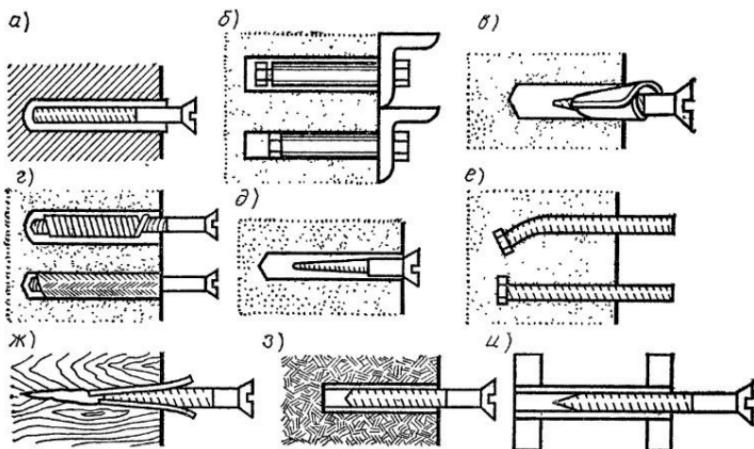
Установка и крепление шурупов и болтов в стенах
